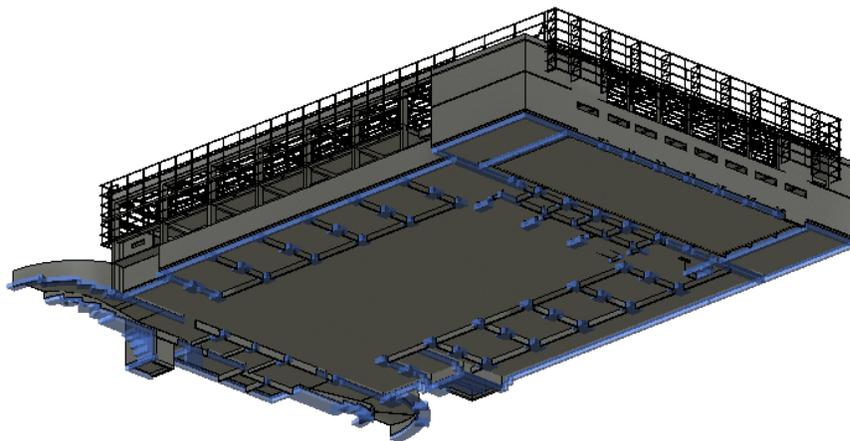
Vista 3D en Autodesk Revit de las fundaciones seleccionadas para la cubicación y presupuesto calculado en el ejemplo anterior. Modelo de Estructuras del Centro Deportivo.
